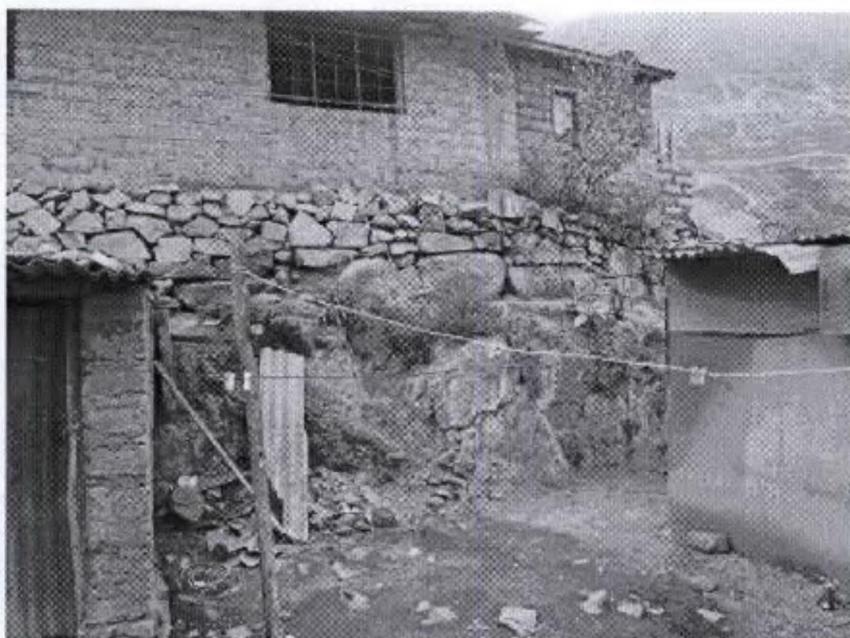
Vivienda de adobe, sobre terraplén inestable, con muro de pirca sin adhesión que amenaza a la vivienda inferior.
